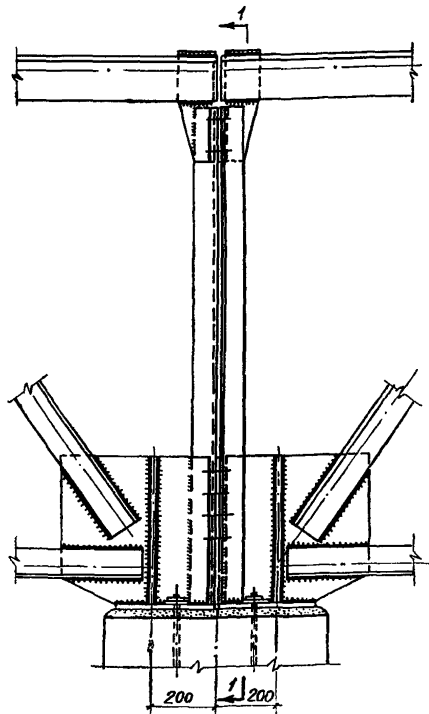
Крепление подстропильной фермы к железобетонной колонне
